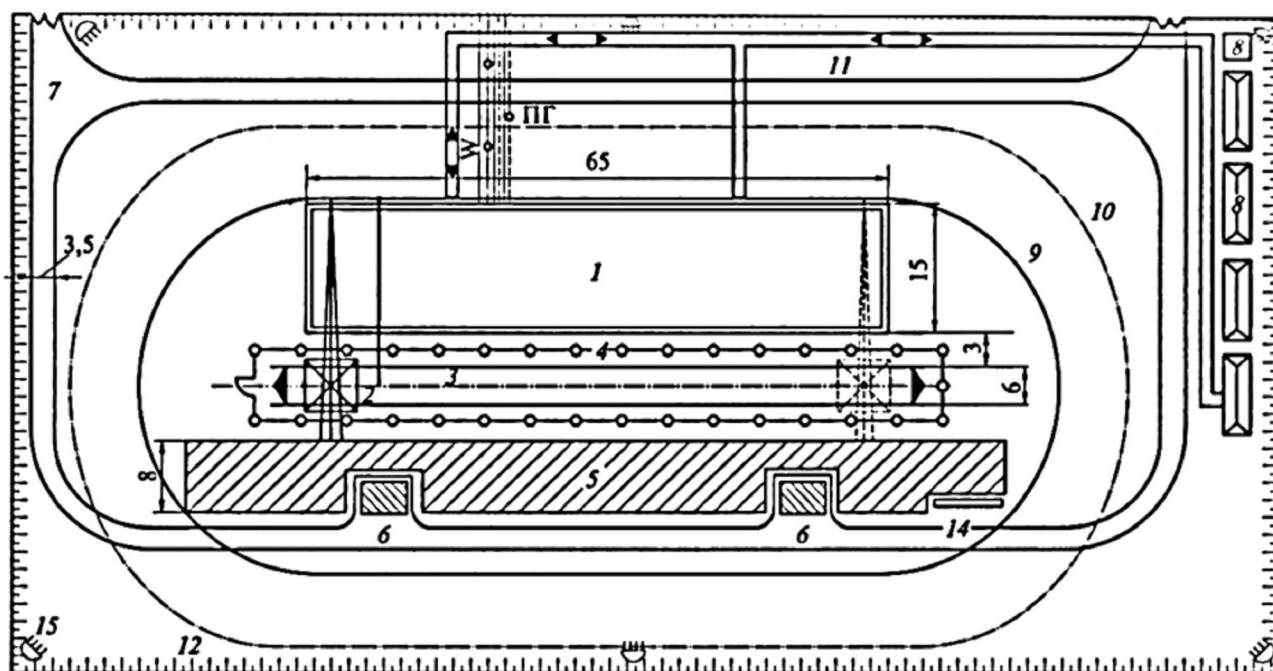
Строительный генеральный план многоэтажного жилого дома, монтируемого башенным краном
